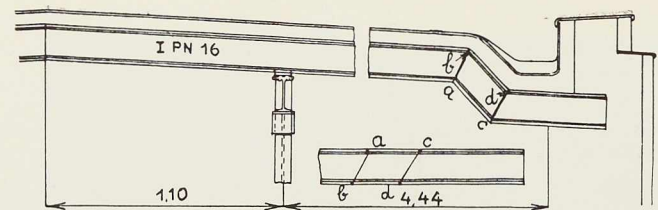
Ferme construite au moyen d'une poutrelle IPN 16, sans aucun déchet de matière.
